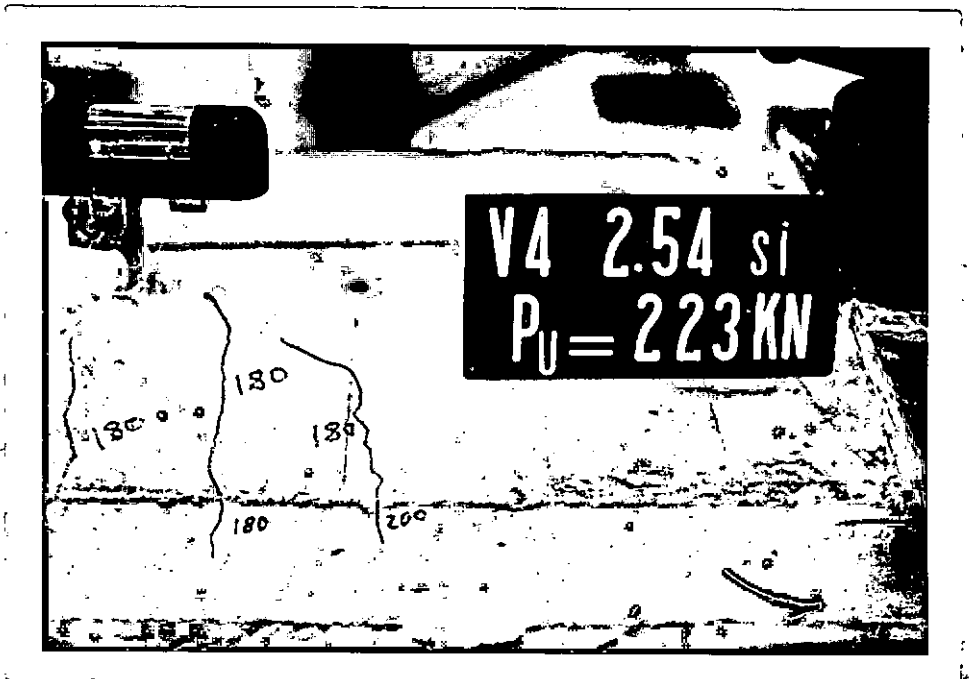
Fissuração na mesa superior da V4-2,54-SI
